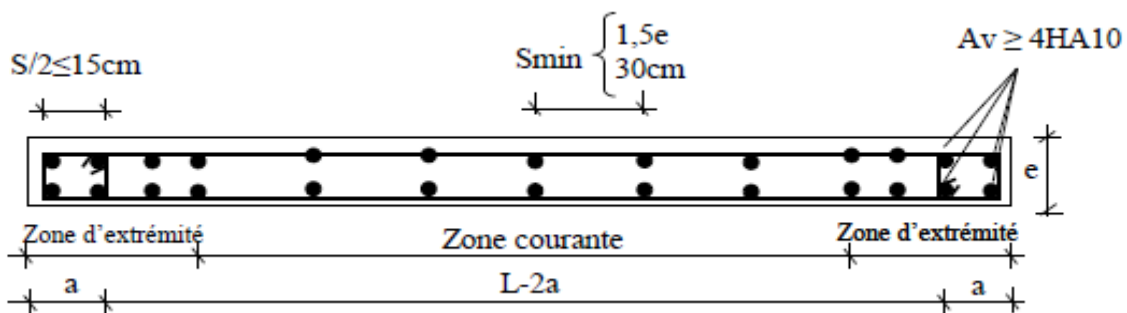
disposition des armatures verticales dans les voiles.
